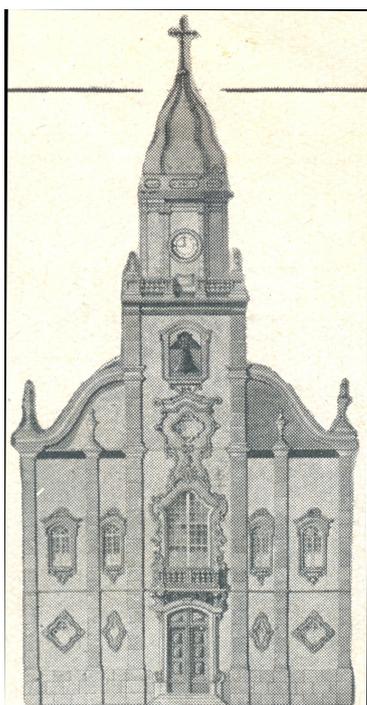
Ilustração de fachada da Igreja Matriz, ainda em construção (Caldeira, 1934:35)
